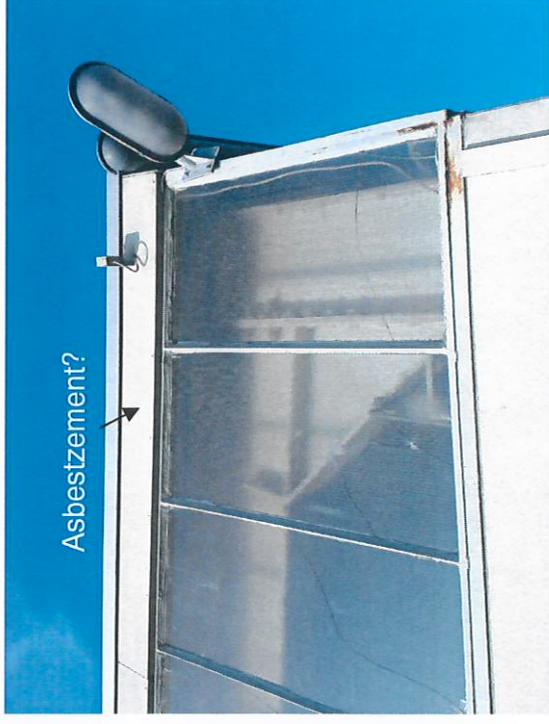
Halle 25: Fensterleiste mit asbestverdächtigem Kitt
